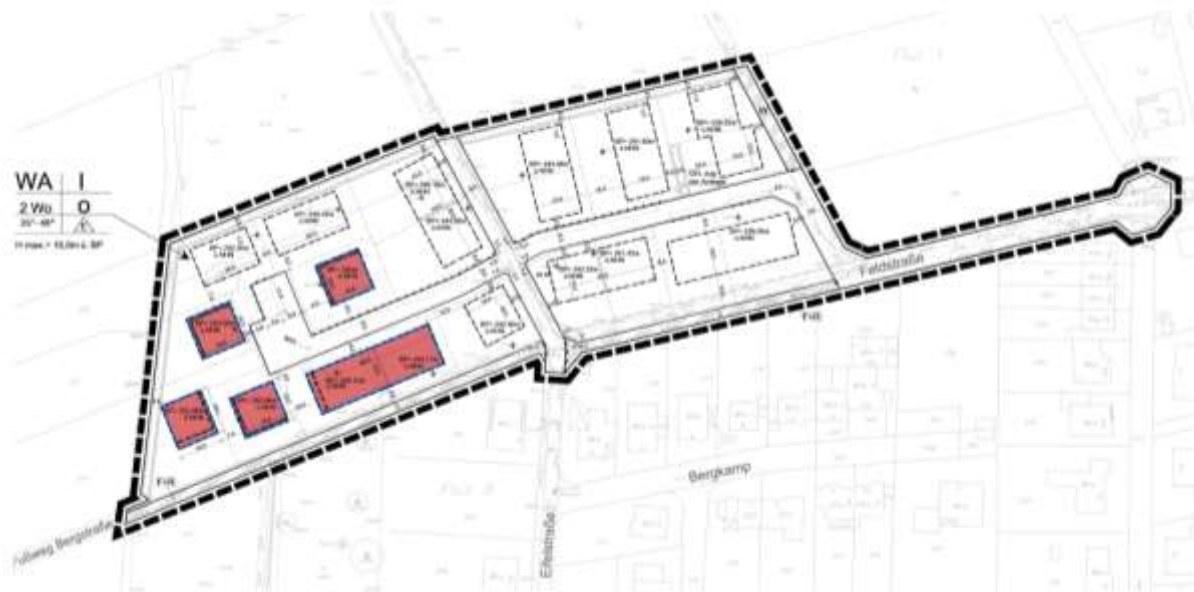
Bebauungsplan C 4 „Feldstrasse/ Thea-Paulus-Straße“, 1. Änderung, Stand: 10.01.2013 (ohne Maßstab)
